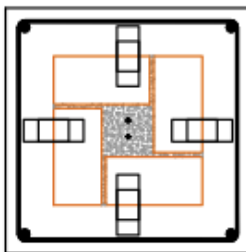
Refuerzo de pilar mediante encamisado de hormigón. Fuente propia.
